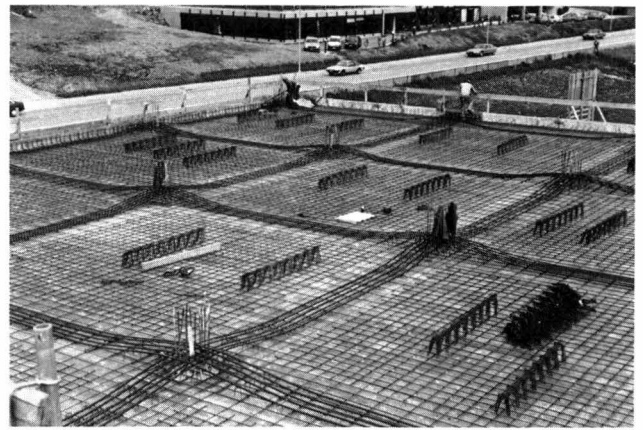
Decke über Niveau 3, Block C. Stützstreifenvorspannung mit Kabeln Typ Cona – Câblage type Cona pour la précontrainte des bandes d'appui. Dalle sur niveau 3, bloc C – Slab over level 3, block C. Supporting strips prestressing by means of type Cona cable
